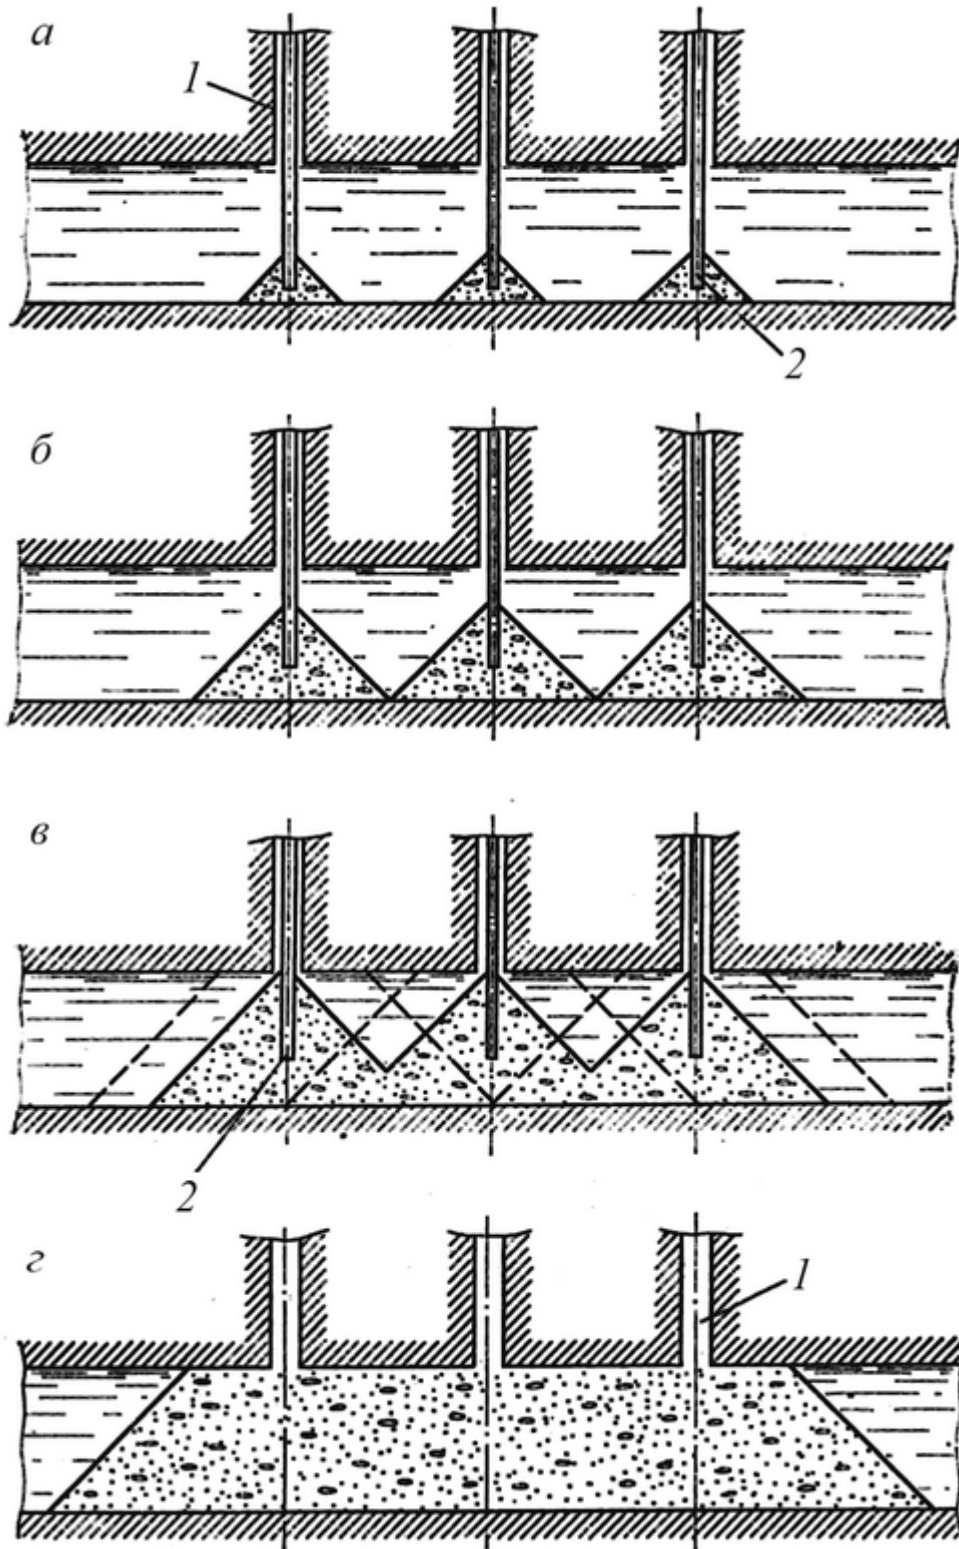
Схема подводного бетонирования при строительстве подводной водонепроницаемой перемычки в затопленной выработке: *a* – образование бетонных холмиков-затворов у вертикально перемещающихся труб; *б* и *в* – укладка вертикально перемещающимися трубами бетона внутрь ранее уложенного; *г* – построенная подводная перемычка; *1* – буровые скважины; *2* – вертикально перемещающиеся трубы
